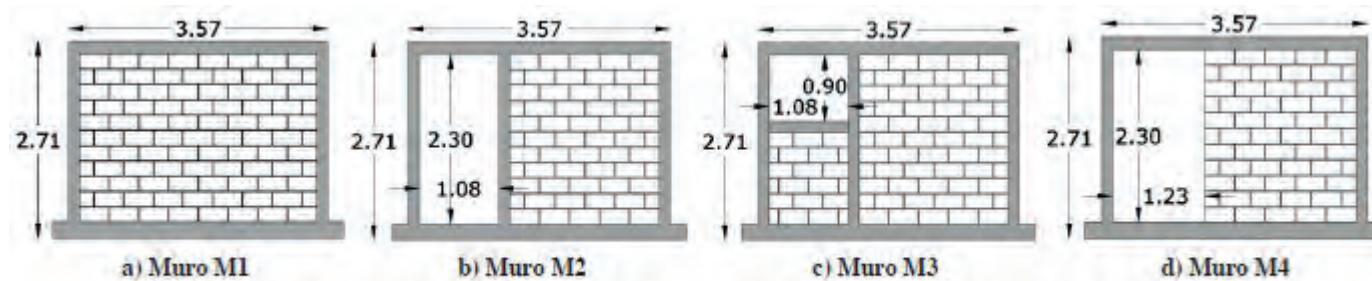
Detalles de la geometría de los muros (unidades en metros).
